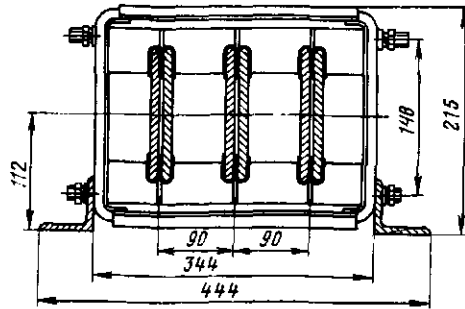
Поперечное сечение шинопровода ШМА68-НУЗ
